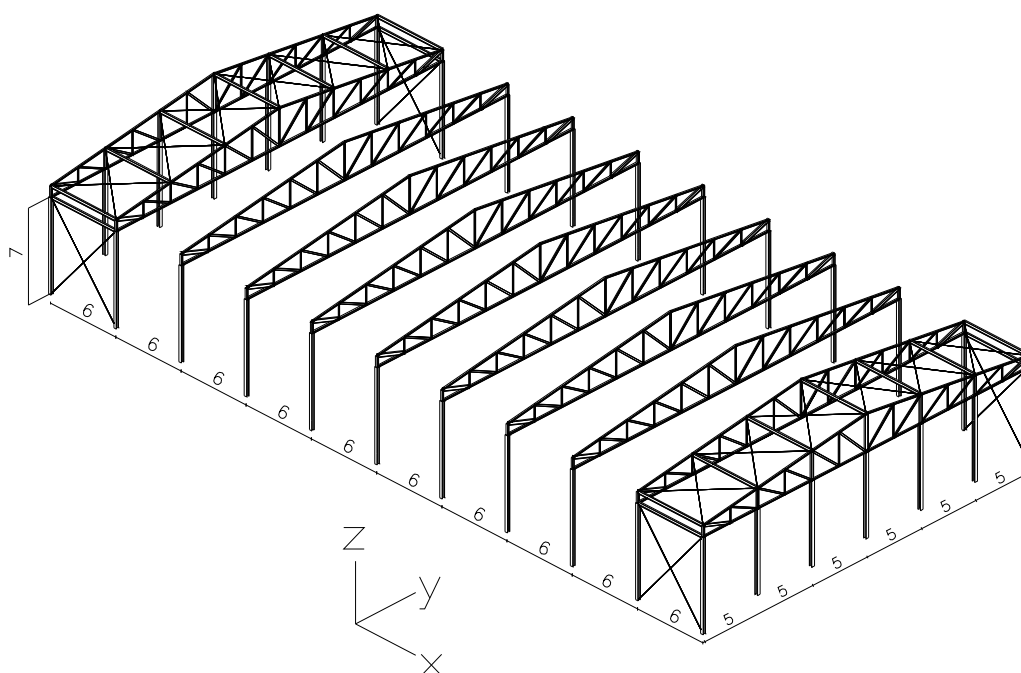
Pavilhão industrial, vão de 30.00m, pórticos com pilar em perfil de alma cheia, viga em treliça, modelo utilizado
